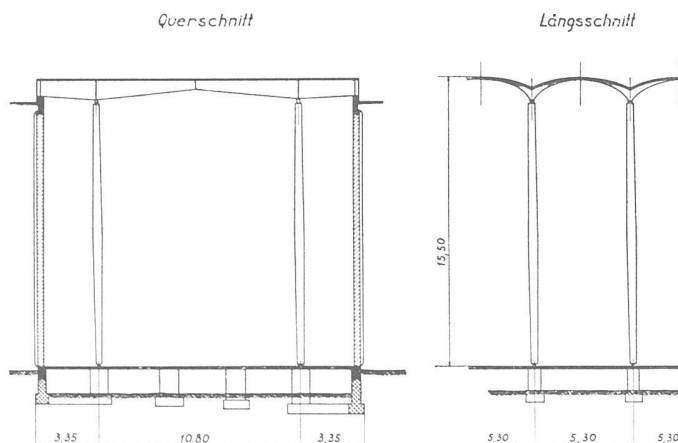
Kirche in Stüßlingen. Hermann Baur, Arch. BSA, Basel. Querschnitt 1:200. Verleimte Vollwandbinder und runde Holzstützen. Außenwände nicht tragend, durch Eisenbetonriegelwerk mit Dachbinder verbunden (Windübertragung) | Coupe transversale. Sommier en bois collé, piliers en bois rond. Murs extérieurs non portants, rattachés à la ferme par des montants en béton armé (contreventement) | Cross section. Girders and circular columns made of wood. Non-bearing exterior walls with reinforced skeleton, tied together with the girders (wind bracing)
